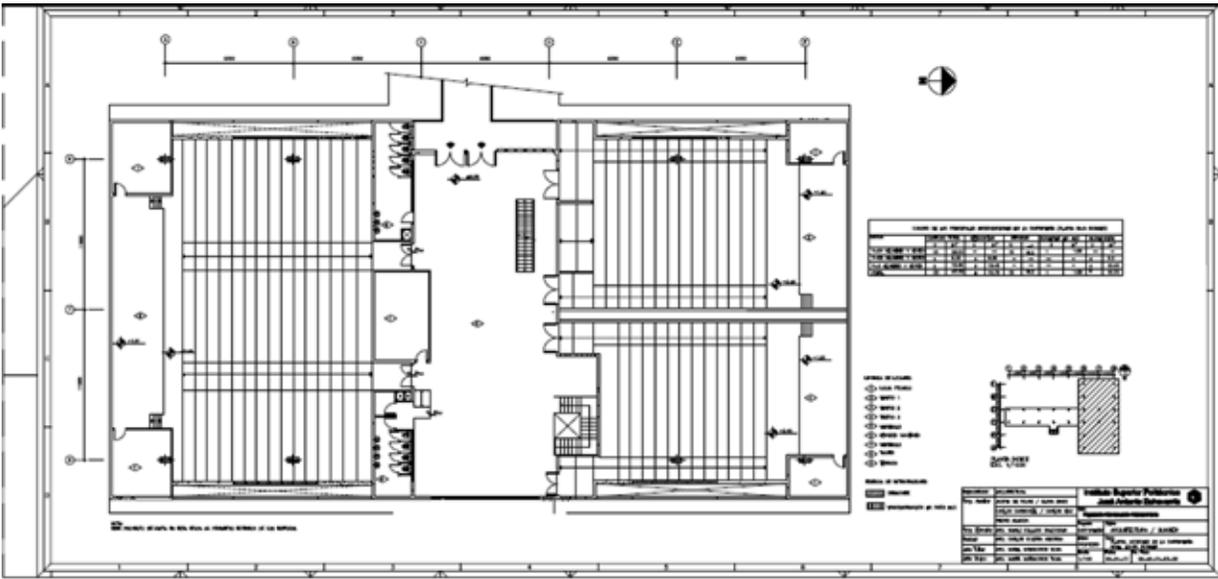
Plano de carpintería de los anfiteatros de Arquitectura.
